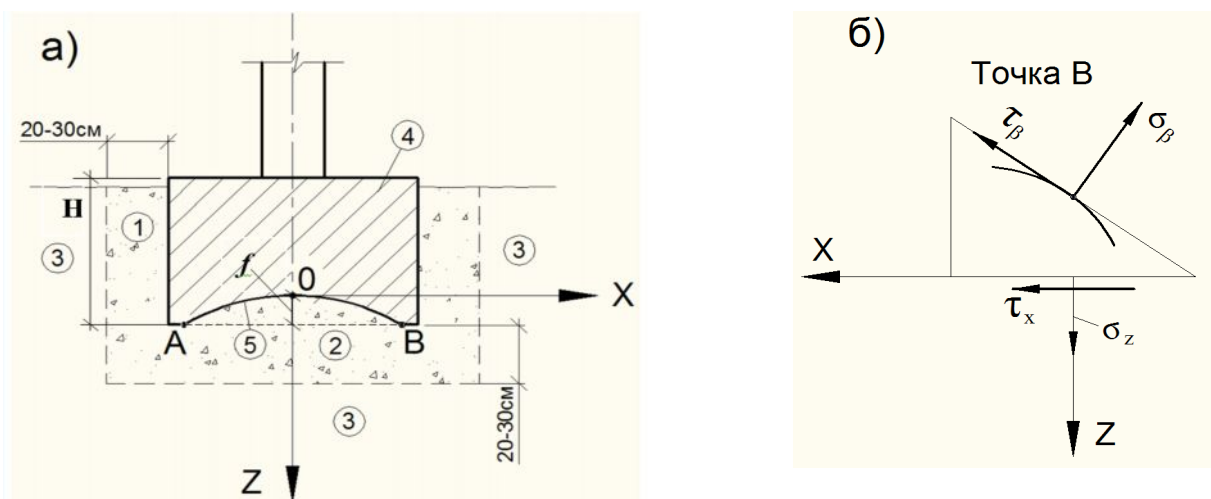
Конструкция фундамента вогнутой подошвой с сейсмоизолирующим песчаным слоем:
